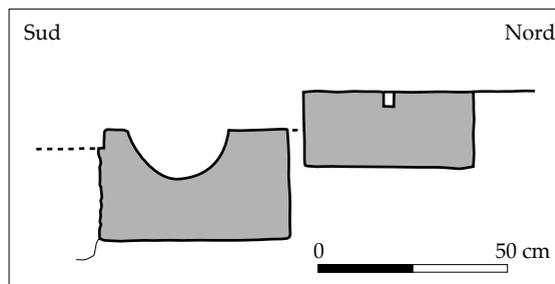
Coupe du mur stylobate et du caniveau du portique 36 (A. Bouet).
